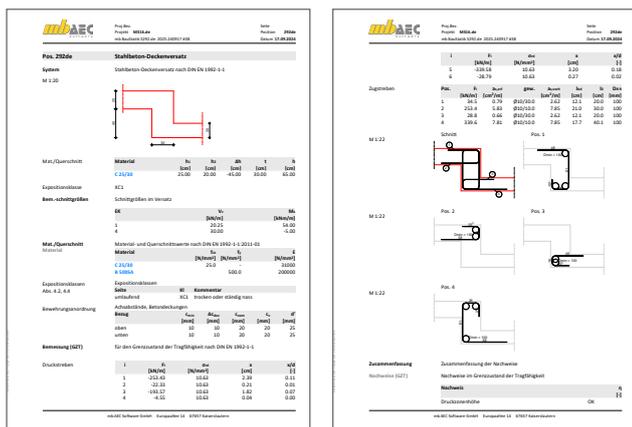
Bemessung in Querrichtung mit BauStatik-Modul S292.de
